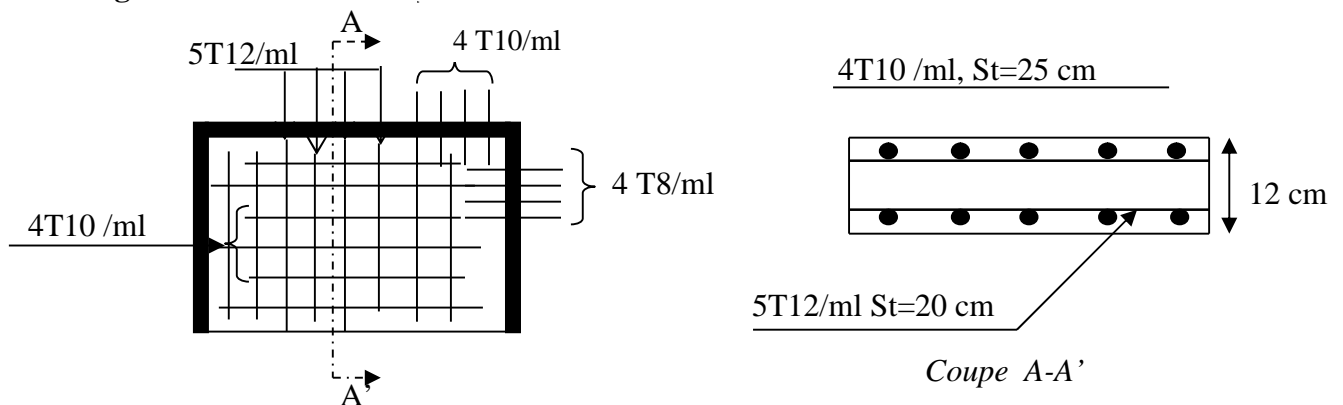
Schéma du ferraillage du balcon sur trois appuis
